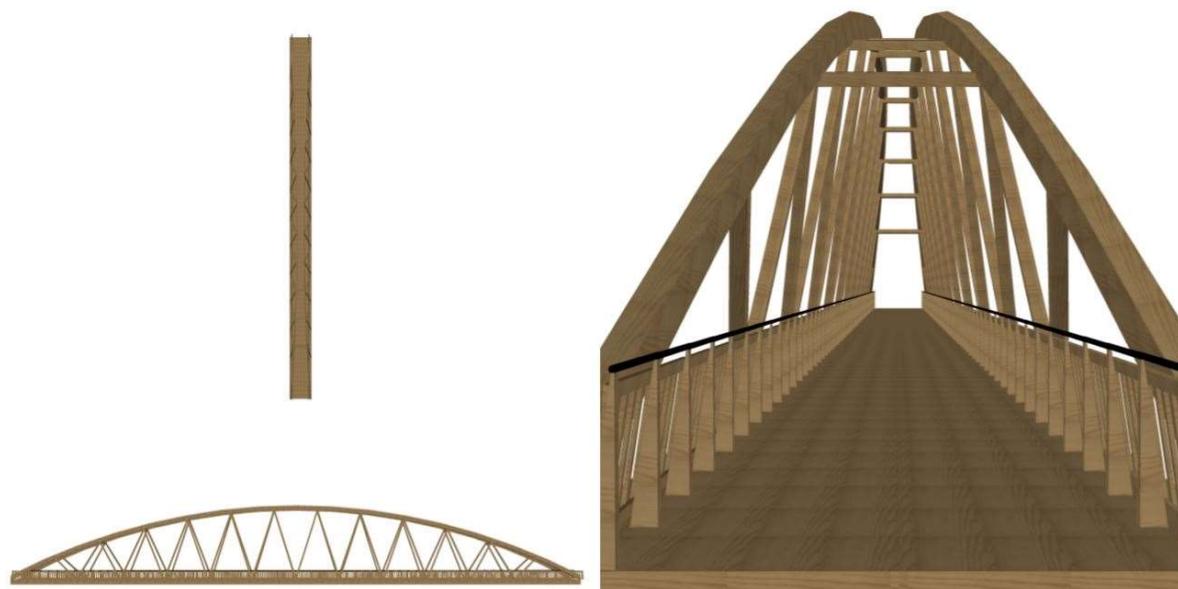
Vistas 3D del tramo central de la pasarela formado por un arco atirantado tipo "Bowstring". Fuente: Propia/AutoCAD 3D.
